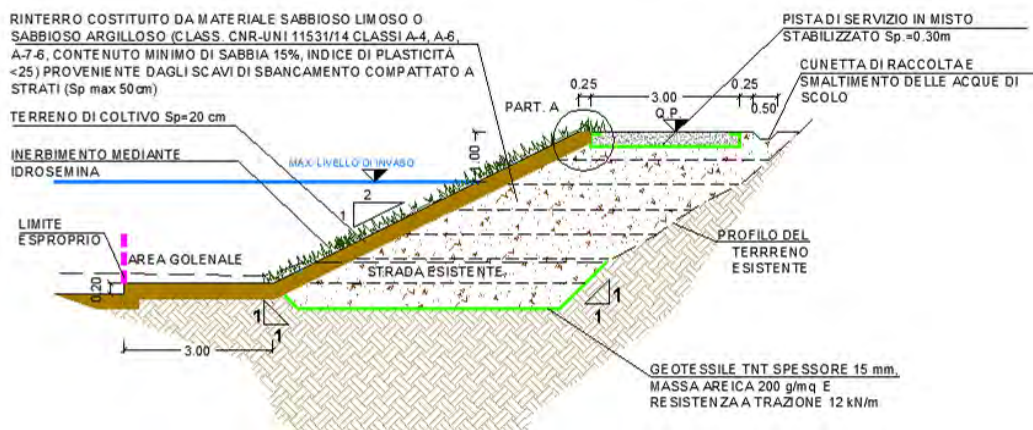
Sezione tipo di rialzo della viabilità esistente
